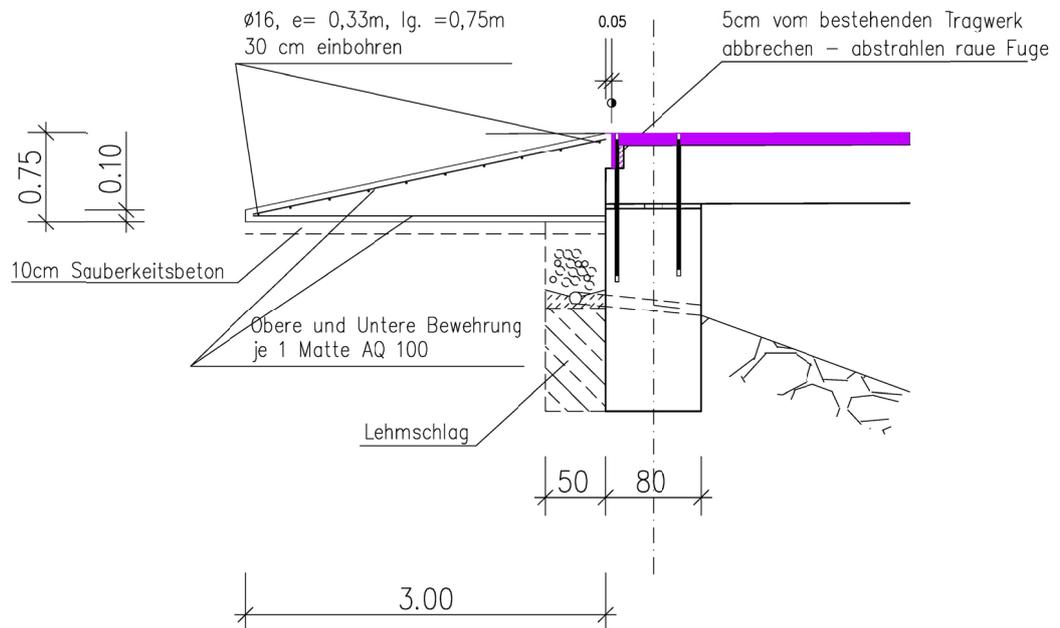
Detailausbildung Schleppplatte Objekt 16017 [54]
